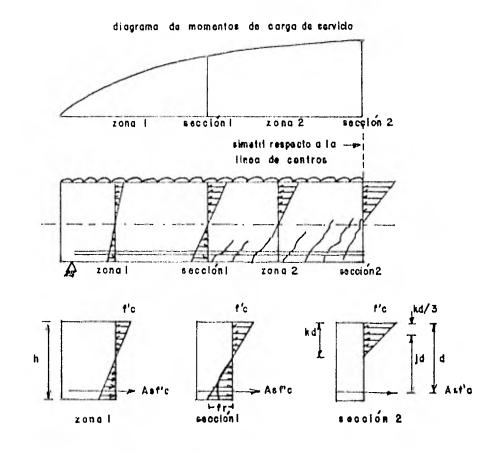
diversas zonas de esfuerzo y agrietamiento en una viga de concreto reforzado.
